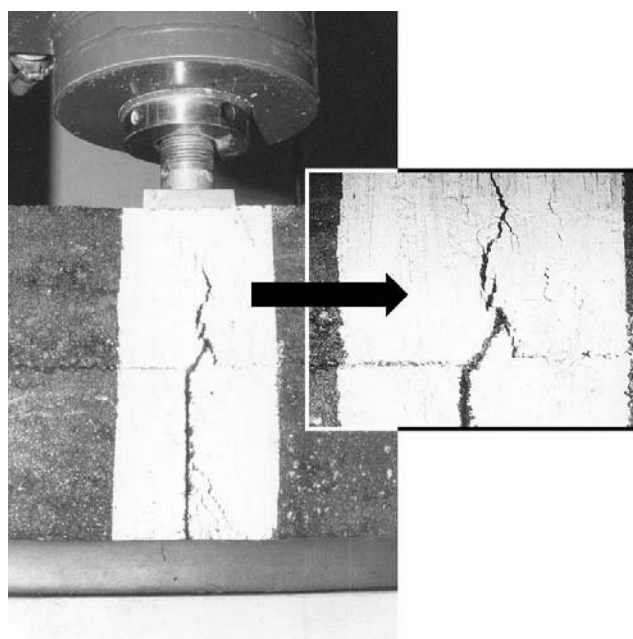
Propagação da trinca na posição de flexão nas vigas convencionais.
